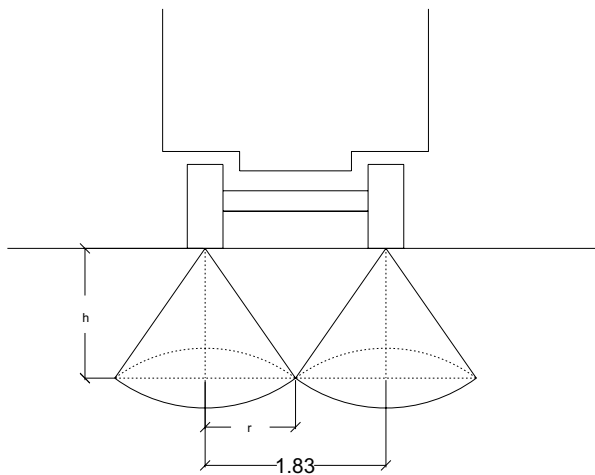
, Carga viva que trasmite el camión a la estructura del pavimento.
